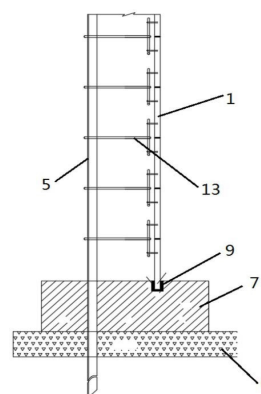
Соединения ступенчатой платформы и подпорной стены, схема установки опорных стоек и крепления сборных панелей. Сборные железобетонные панели (1), опорные элементы (5), монолитная, угловые стальные стойки (5) дренажный слой из щебня (6), бетонная плита (7), монтажные пазы (9) горизонтальные стальные связи (13)
